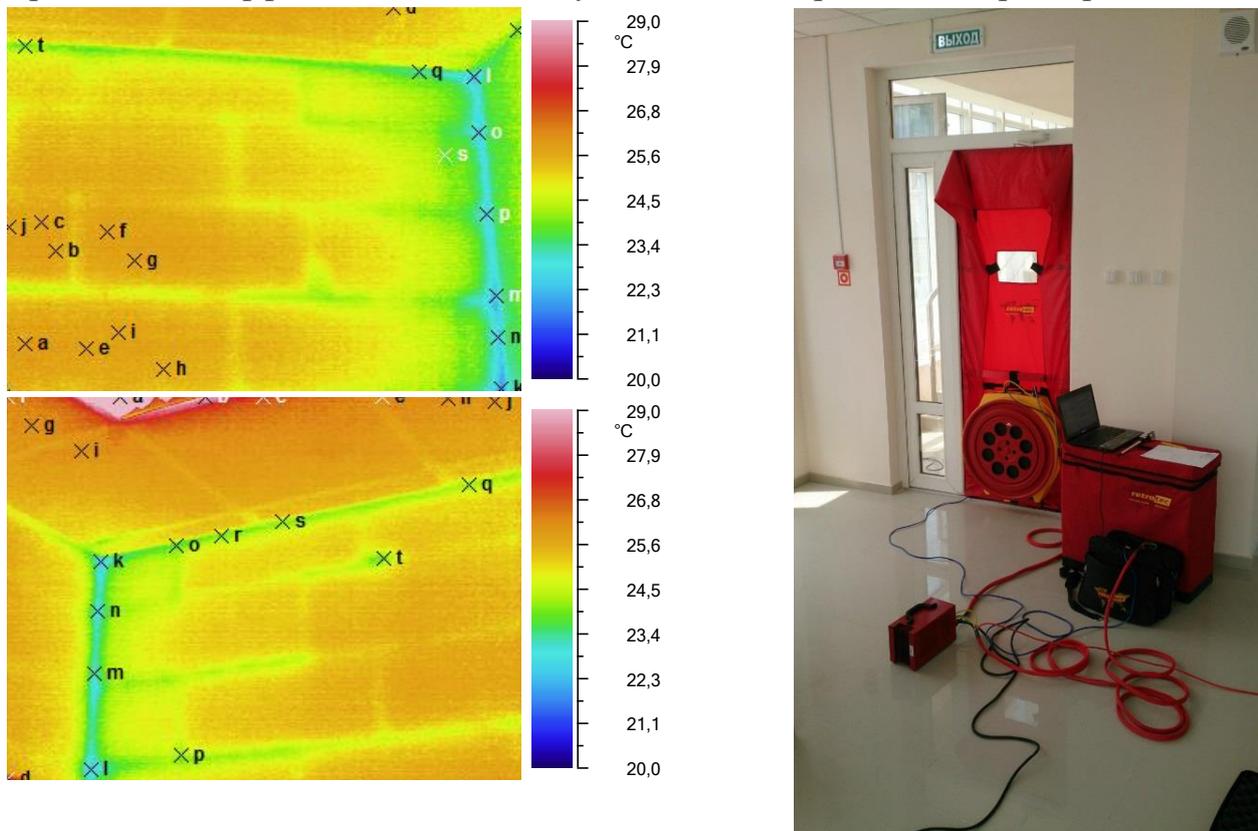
Совместное использование тепловизора и аэродвери для обследования зданий с вентилированной фасадной системой.
